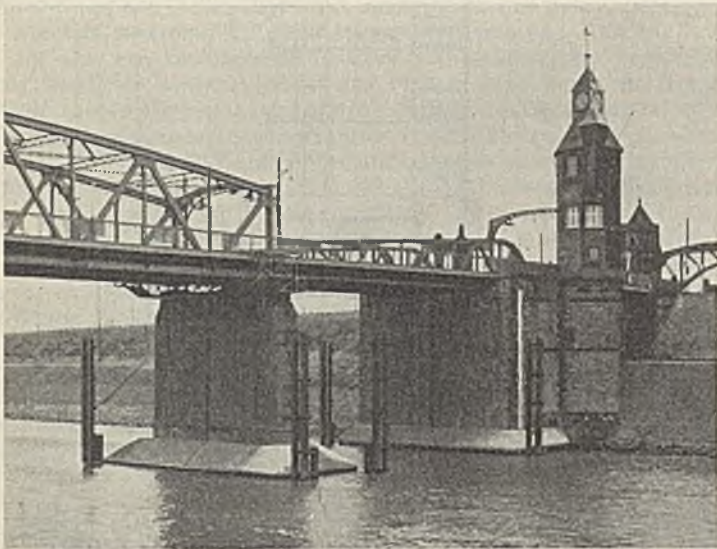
Gesicherte Grundwerke der Oberbürgermeister-Lehr-Brücke II.
